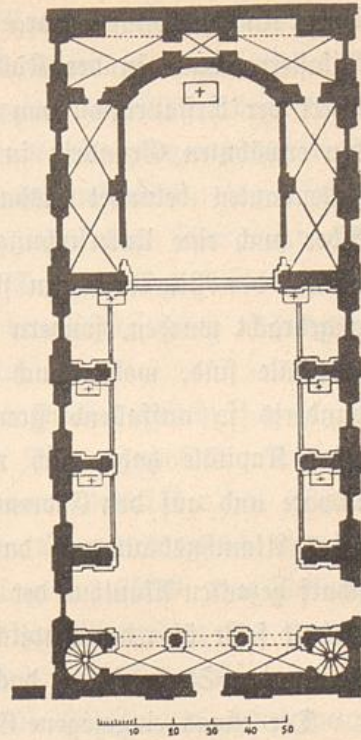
Dillingen. Mariä-Himmelfahrtskirche. Grundriß. (Nach Originalgrundriß.)
